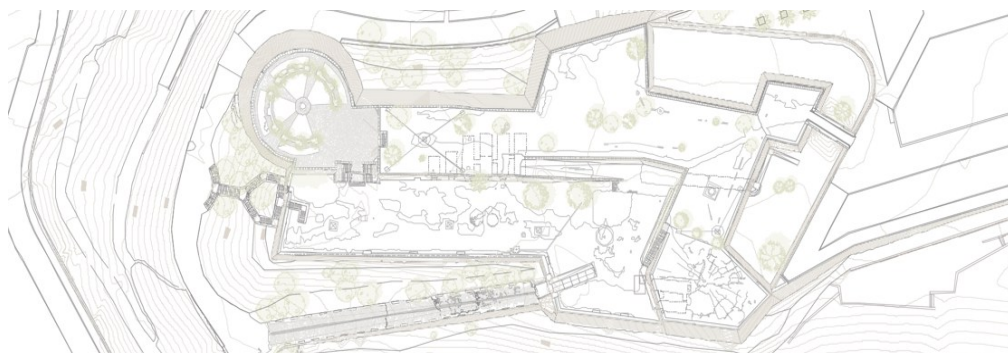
Levantamiento de la planta del Castillo de San Fernando de Alicante (Ismael Pizarro, 2018)
